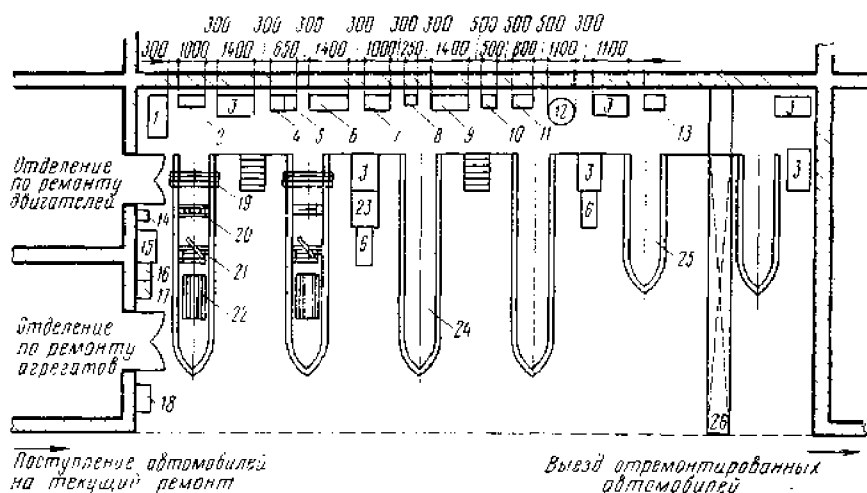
Планировка рабочего места слесаря по замене агрегатов: 1 – установка для прокачки тормозов; 2 – комплект инвентаря для заправки автомобилей; 3 – слесарный верстак с тисками; 4 – тумбочка для инструментов; 5 – гайковерт для гаек 16 мм; 6 – полочный стеллаж для деталей; 7 – шкаф для приборов и приспособлений; 8 – урна для обтирочных материалов; 9 – стеллаж для инструментов; 10 – ларь для утиля; 11 – заточный станок; 12 – металлический стеллаж для мелких деталей; 13 – стел паж для метизов; 14 – аптечка; 15 – передвижная моечная ванна; 16 – гайковерт для гаек колес; 17 – гайковерт для гаек стремянок; 18 – гидравлический подъемник; 19 – переходные мостики; 20 – гидравлический подъемник; 21 – механизм для снятия и установки коробки передач; 22 – деревянная решетка под ноги; 23 – тележка для снятия колес автомобиля; 24 – канава для ремонта и установки агрегатов; 25 – канава для снятия и установки двигателей; 26 – кран-балка
